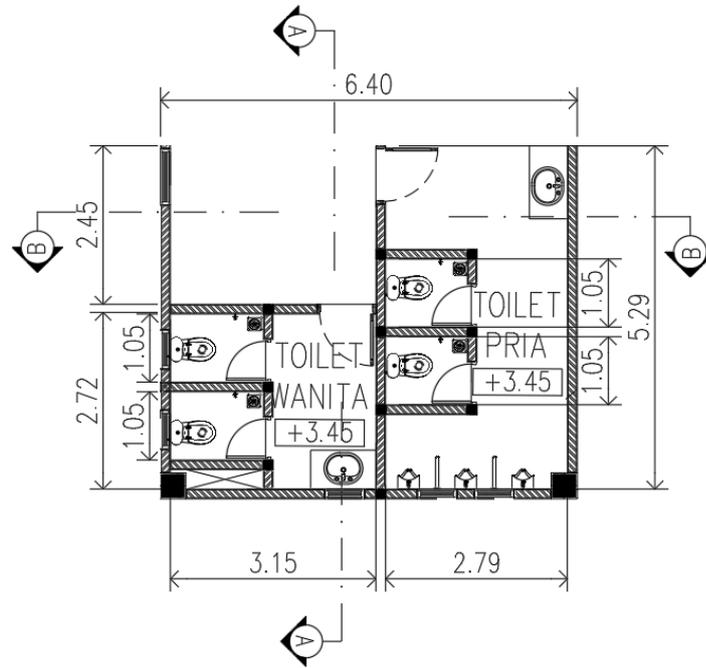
Tanda (Signed) pada Denah Lantai 1 Bangunan GOR
